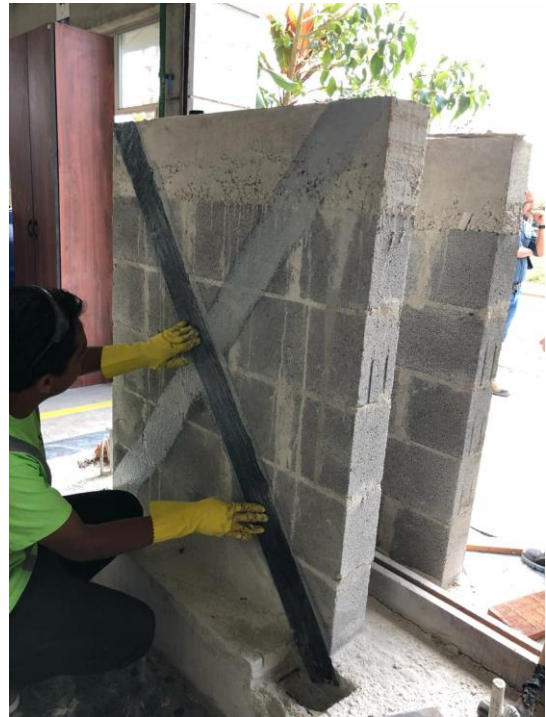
Colocación de las bandas SikaWrap 600C sobre el muro
